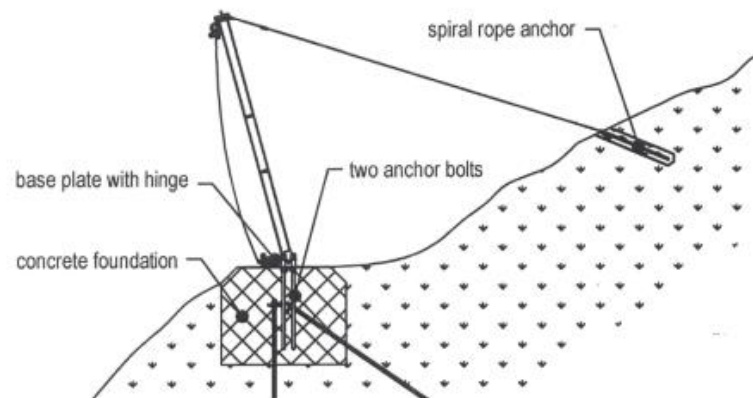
Plano Perfil Barrera RXE (Fuente Geobruigg)
